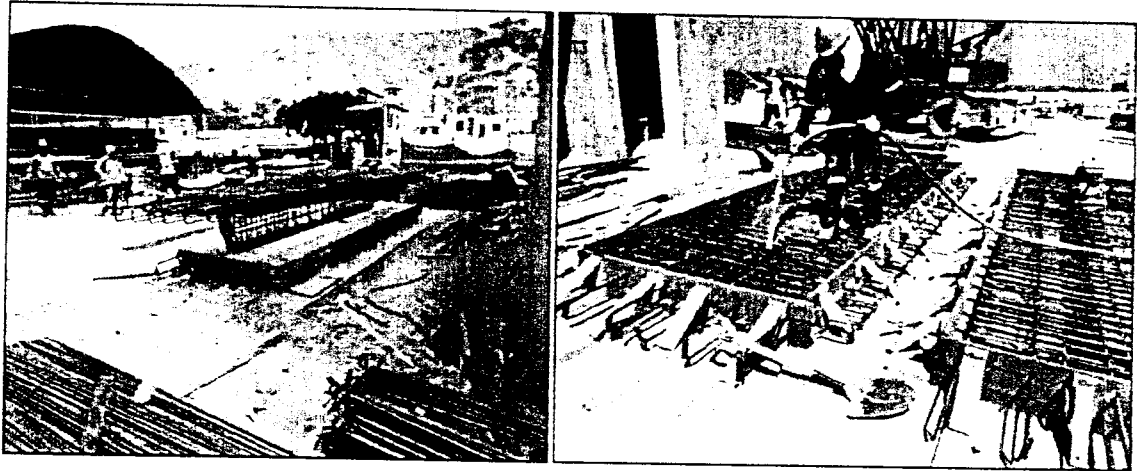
y 2. Habilitación, encofrado y fundido de losas prefabricadas.
